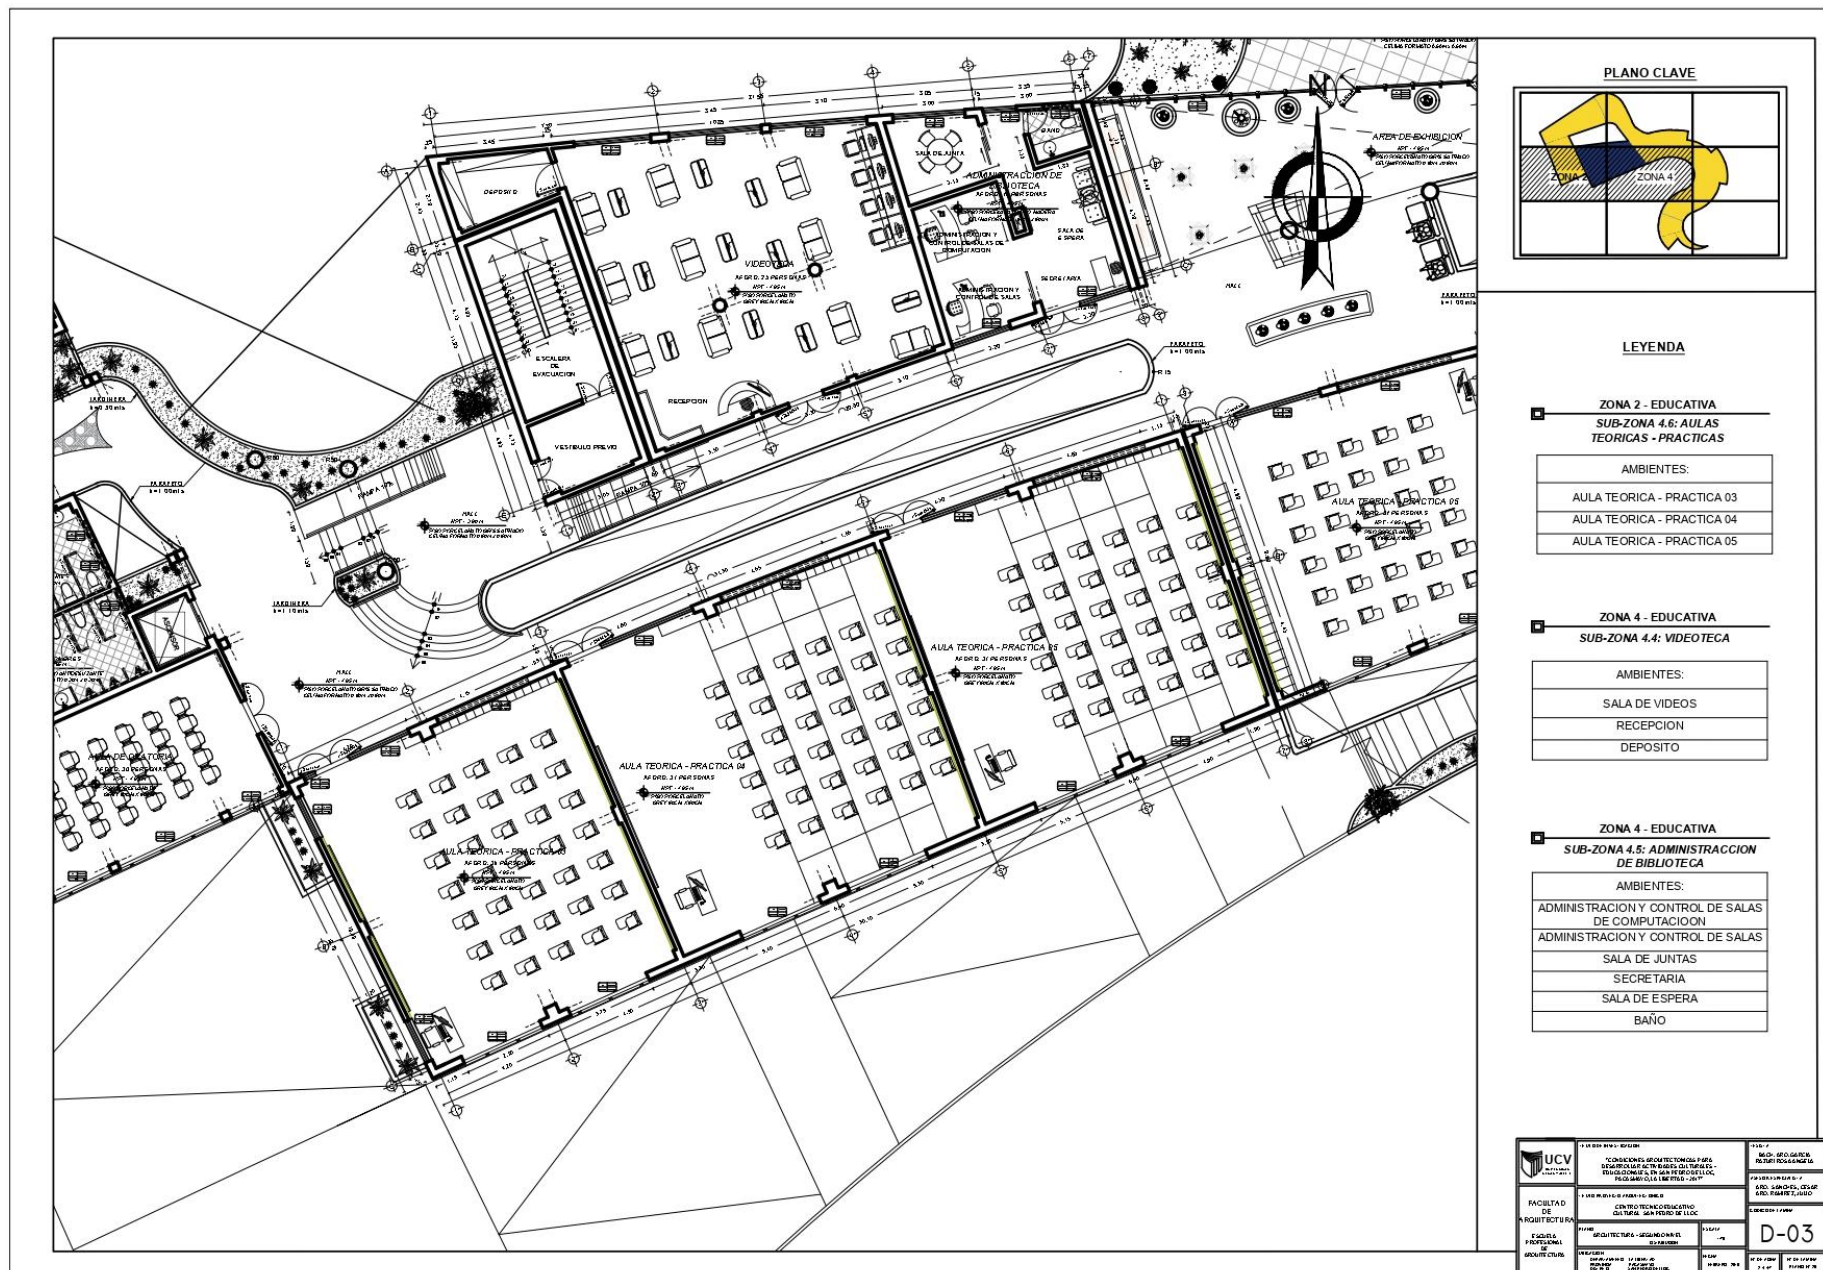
Plano de Desarrollo por Zonas - Plano N° 20 - Lamina N°: D - 03
